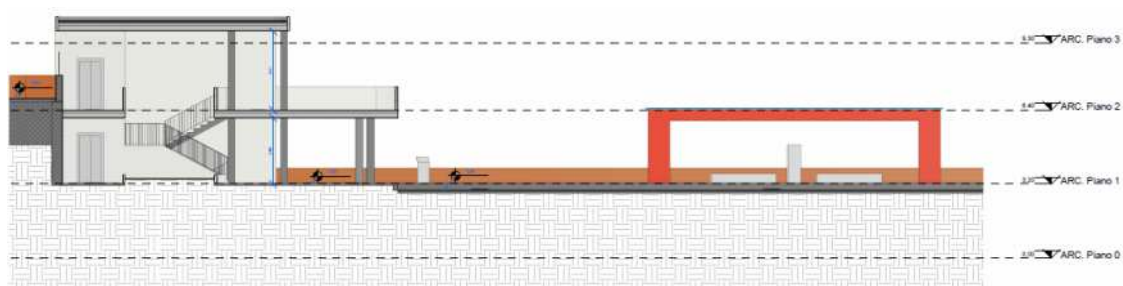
sezione longitudinale sulla banchina del capolinea e sul corpo di collegamento
